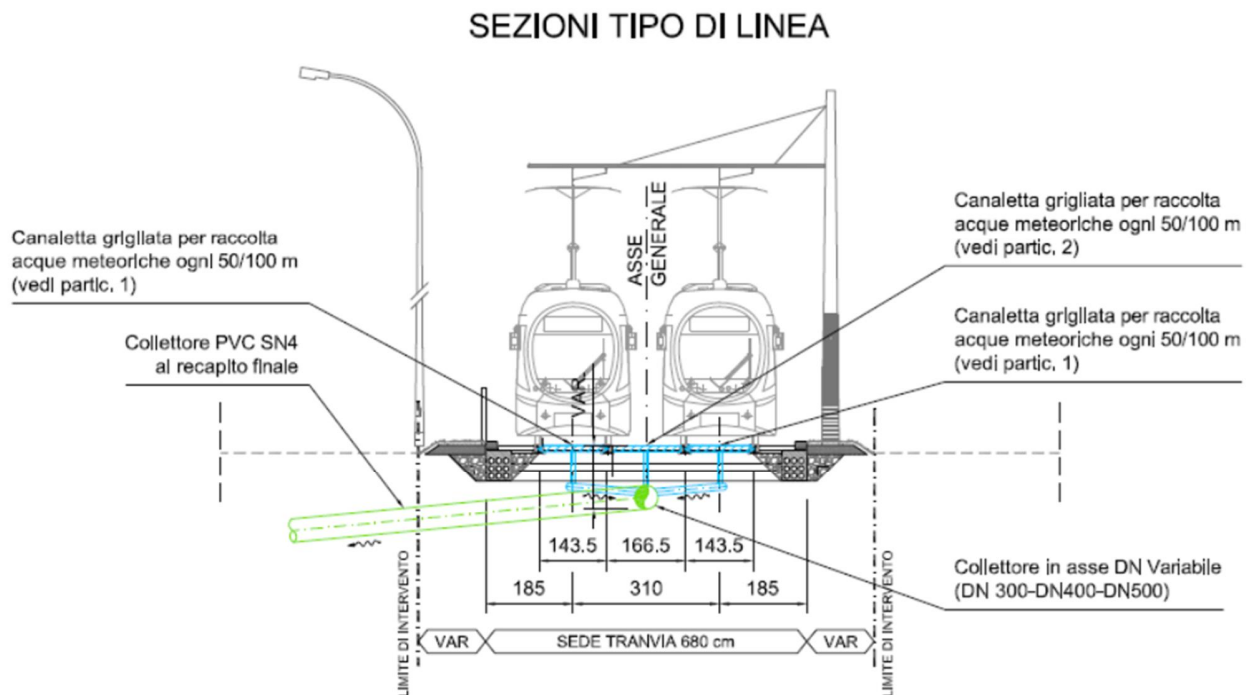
Collettamento acque meteoriche - Sezione tipo di linea su nuova pavimentazione
